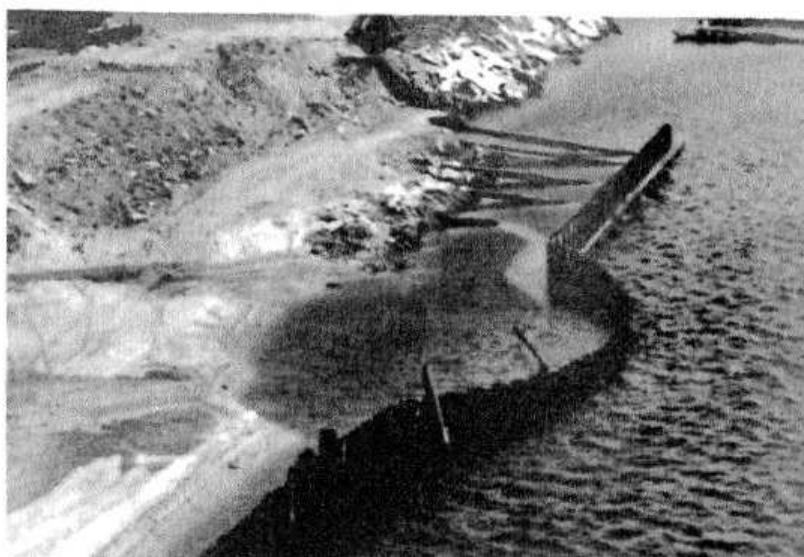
Colapso da cortina de estacas prancha - LaGatta e Shields (1984)
